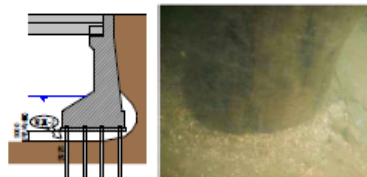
洗掘状況 写真-2 洗掘状況（松杭露出）
